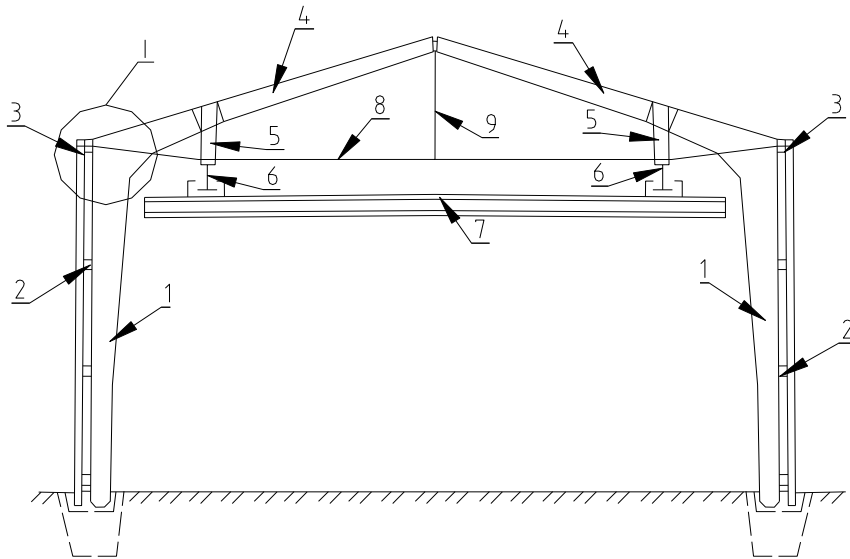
Збірна залізобетонна конструкція рами:
